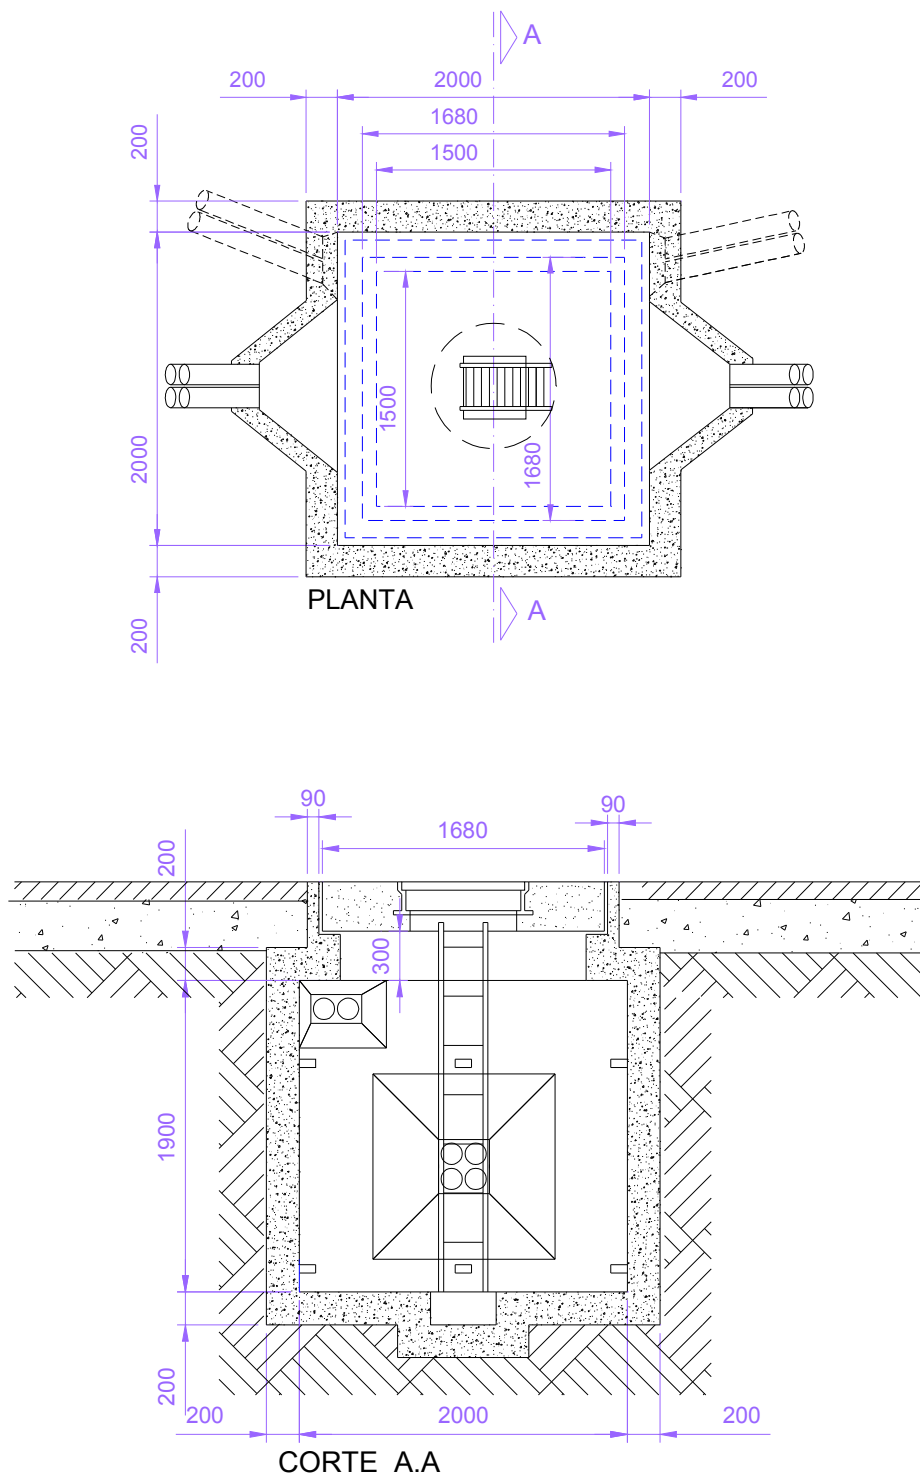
Caixas de inspeção tipo CI-2 (4,00 m x 2,00 m x 2,00 m)
